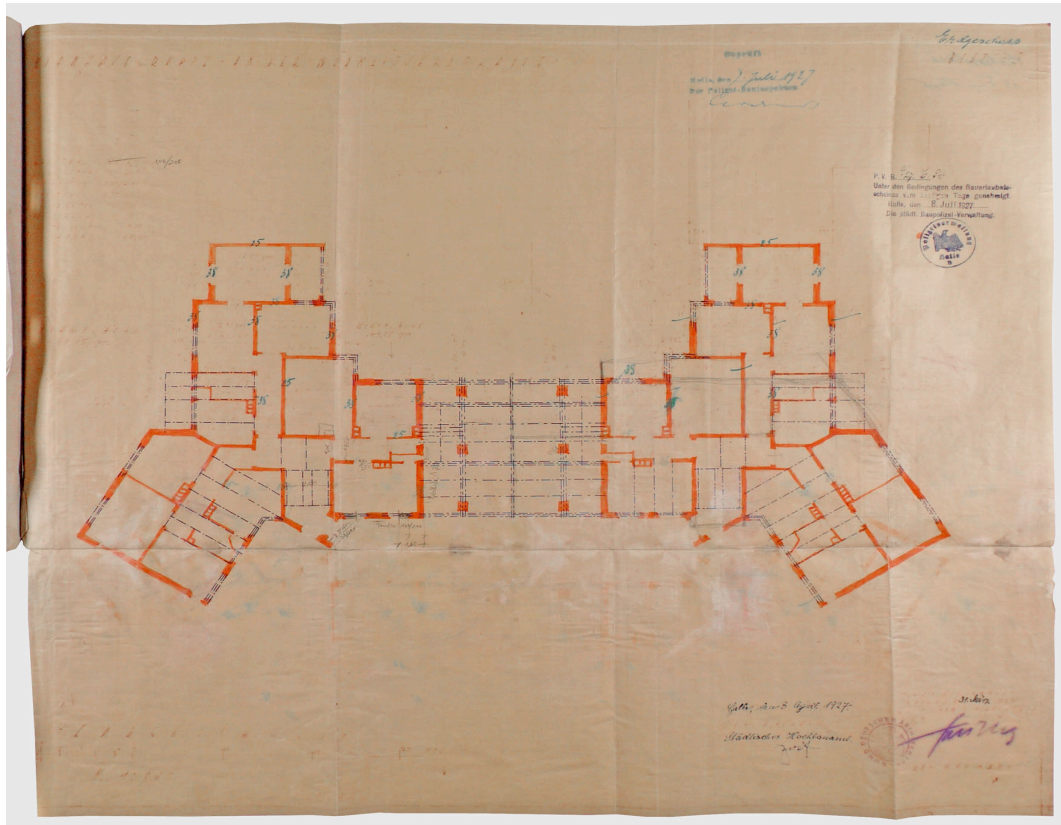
Mehrfamilienwohnhaus in der Max-Lademann-Straße 6 & 7 in Halle, Grundriss Erdgeschoss, datiert 31. März 1927.
